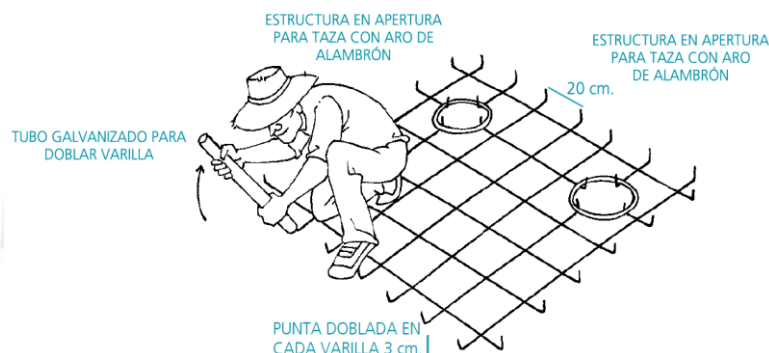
Armado de la estructura de la losa. Fuente: (Salud Sin Límites, 2009).
